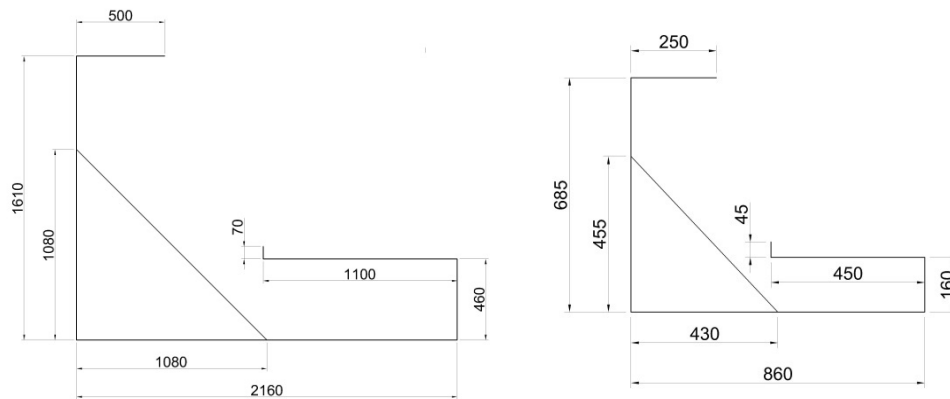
Dimensiones en mm de las barras corrugadas para las piezas de hormigón de siete llaves (izquierda) y de tres llaves (derecha)
